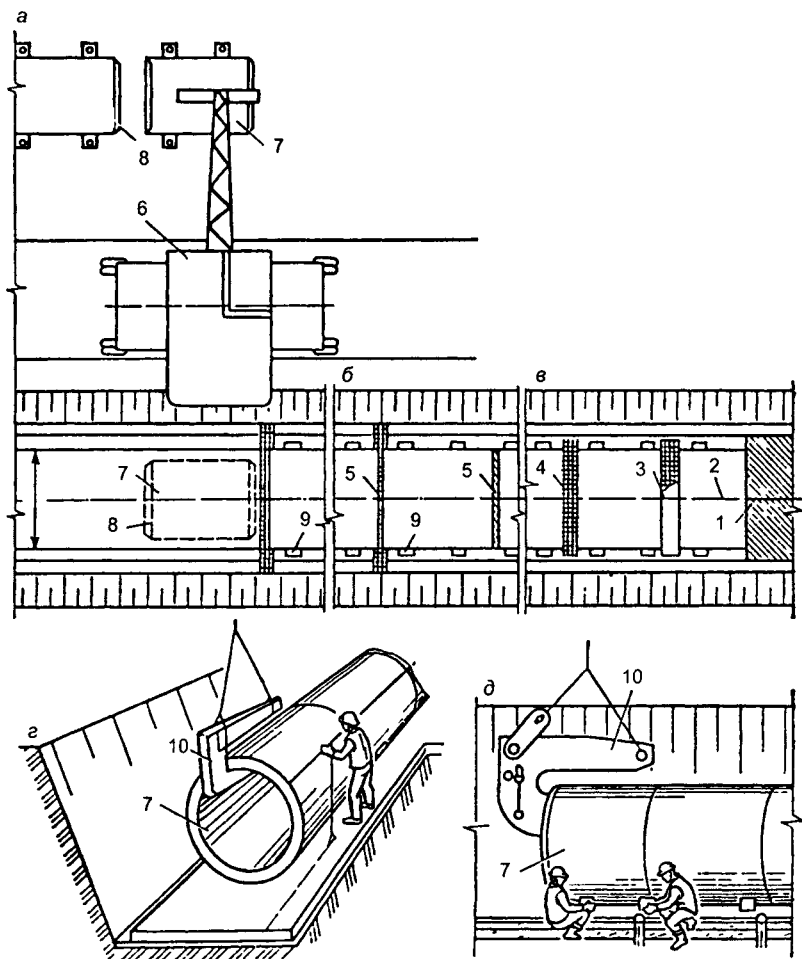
Монтаж безнапорных коллекторов из железобетонных фальцевых труб диаметром 2000 мм:
